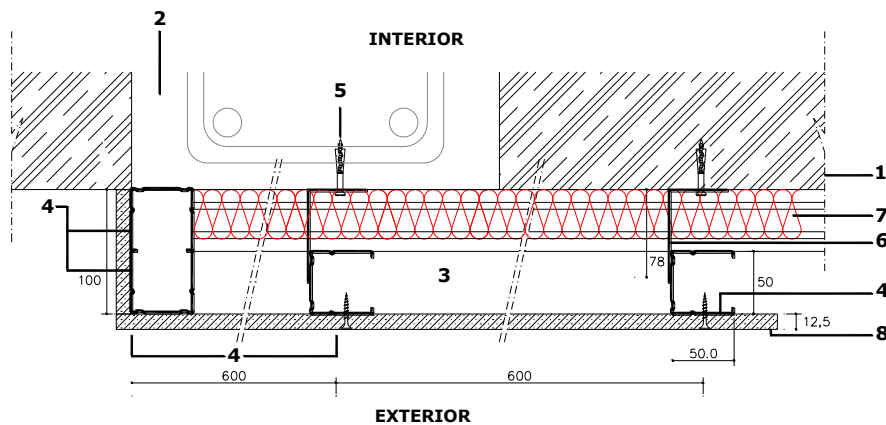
Detalle en planta de la sección de la subestructura para la construcción de los prototipos de (FVL) Fa, Fb y Fd (D')
